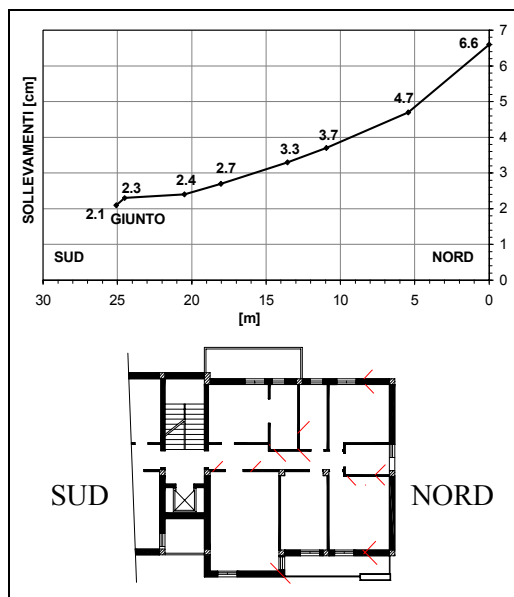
Sollevamenti dei pilastri del corpo A1 e pianta dell'alloggio di seconda elevazione.
